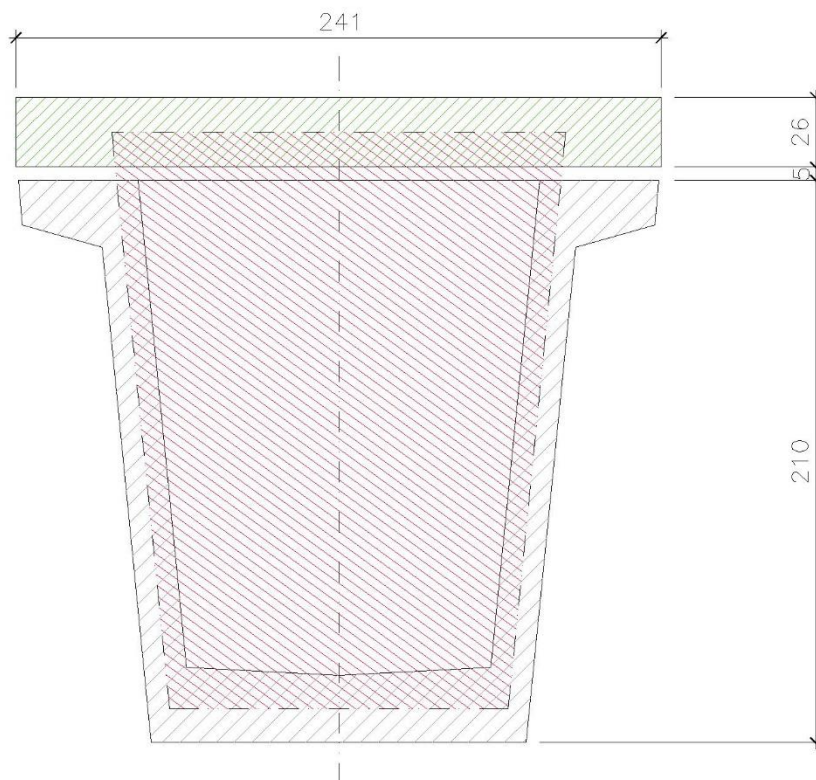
Sezione composta trave prefabbricata + soletta
